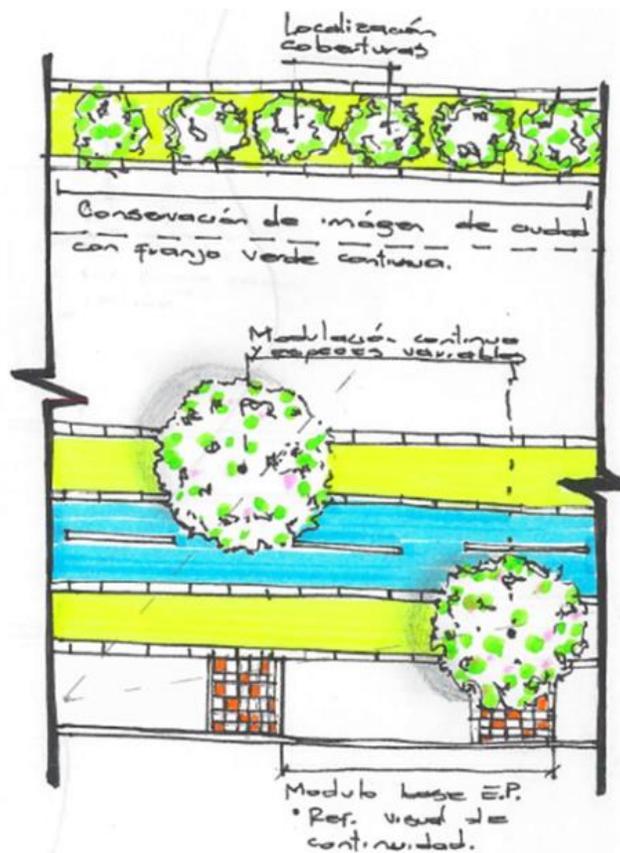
Planta Paisajismo costado norte Unidad Paisajística Gibraltar
